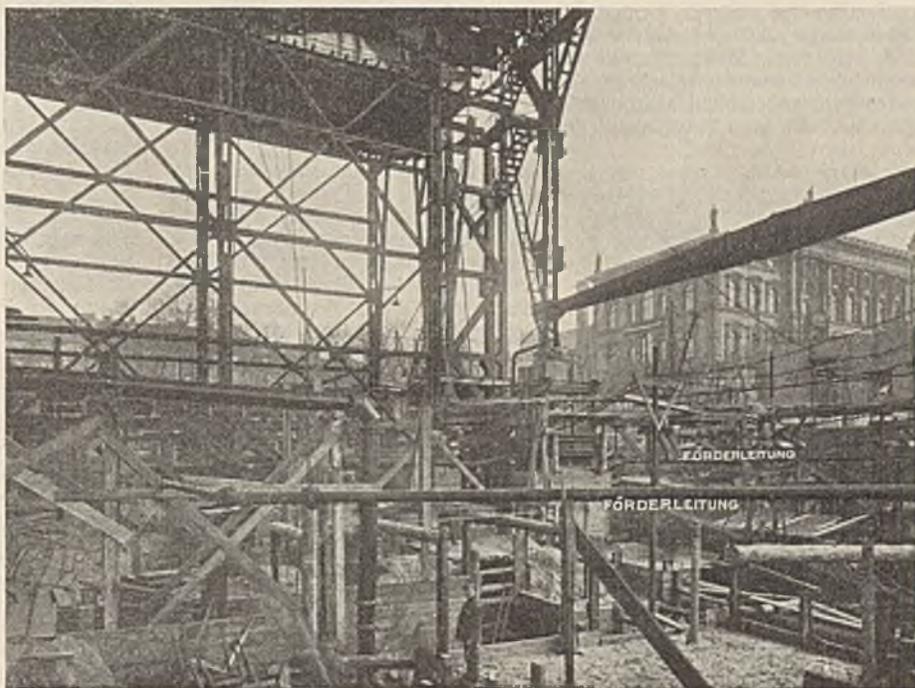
Vortrag Fraenkel: Pneumatische Betonförderung beim Neubau des Opernhauses in Berlin. Gesamtansicht der Baustelle mit zwei Förderleitungen.
